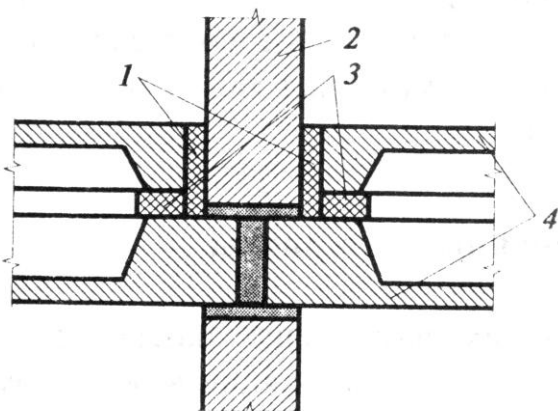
Схема применения звукопоглощающих прокладочных материалов в стыках внутренних стен и междуэтажных перекрытий:
